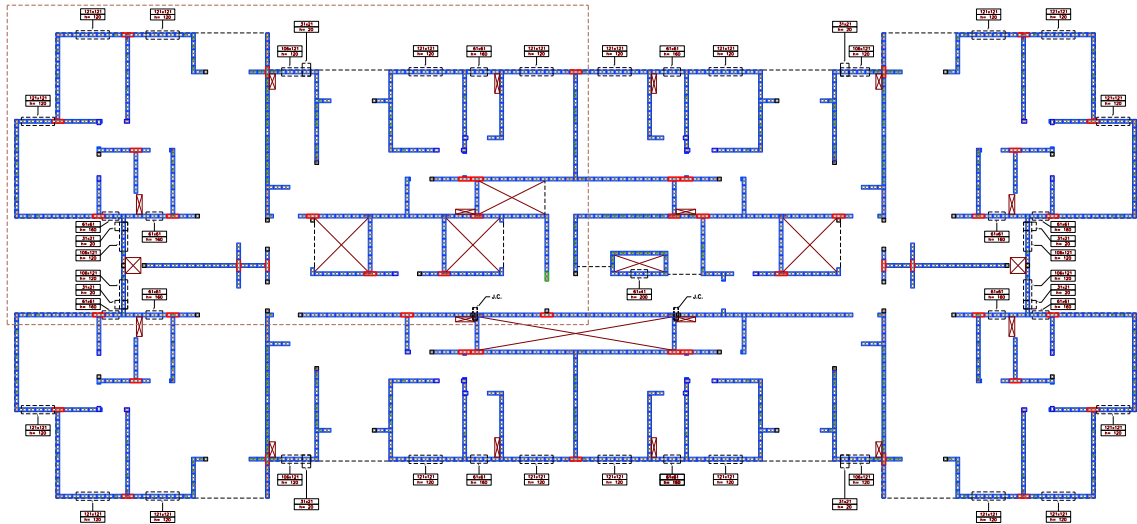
Edifício Vita Belle: planta de modulação do pavimento tipo
